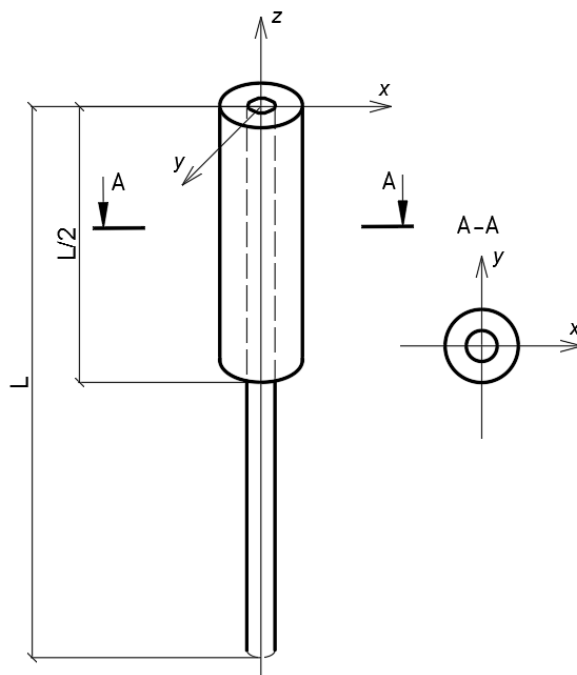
Схема сваи с наружной цилиндрической оболочкой
